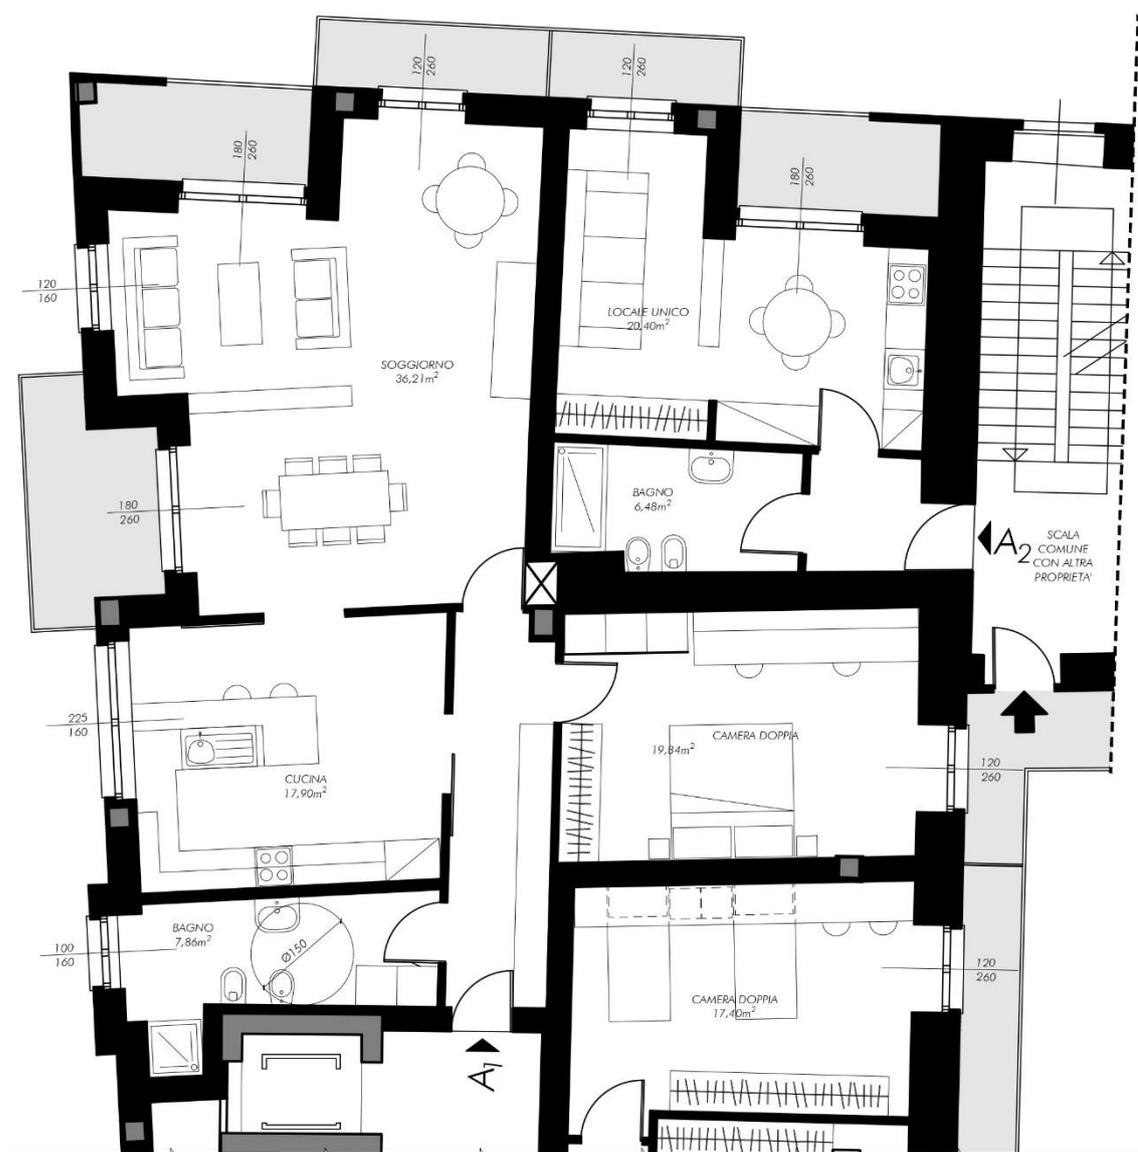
Alternativa di progetto, suddivisione appartamento A monocale e trilocale
